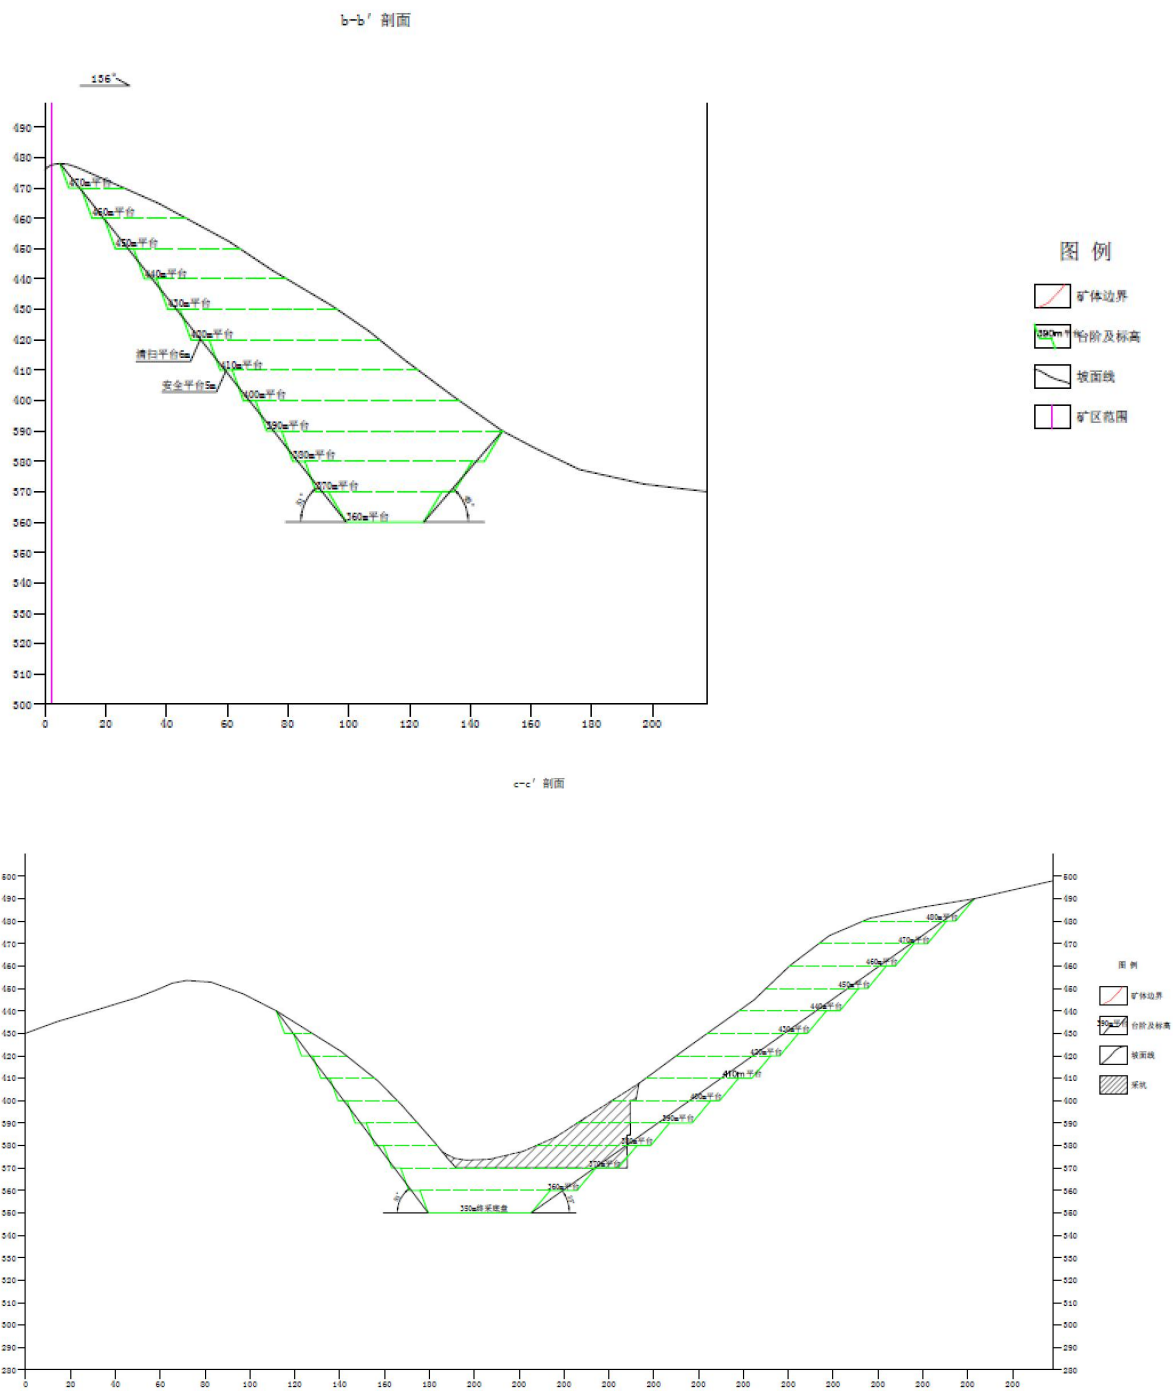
K2 矿体开采终了境界剖面图 (1:1000)
